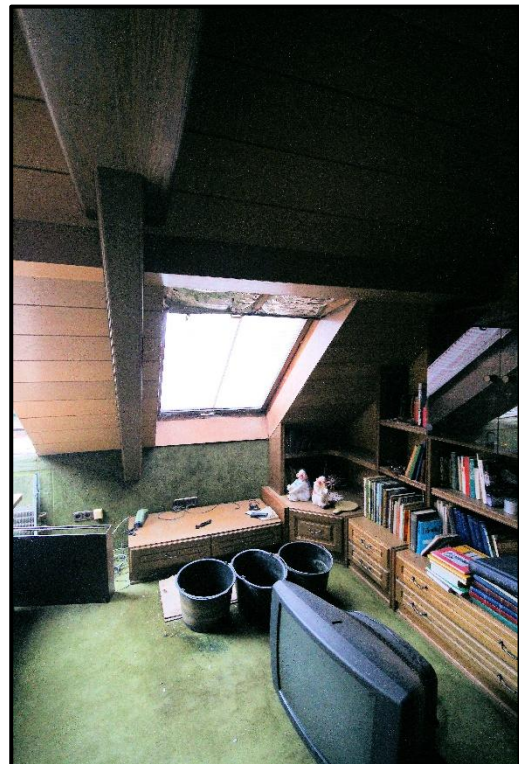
schadhafte Dachflächenfenster im Wohnraum im Dachgeschoss
